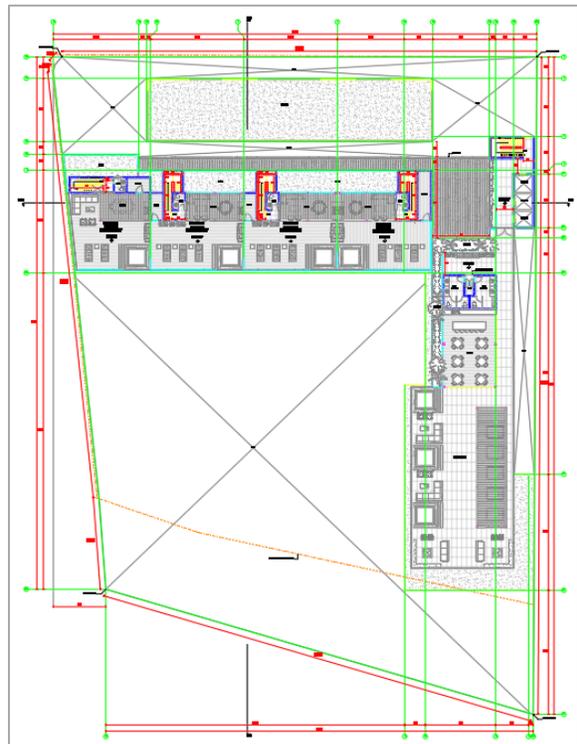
Detalle del diagrama del polígono Roof Garden (azotea)
